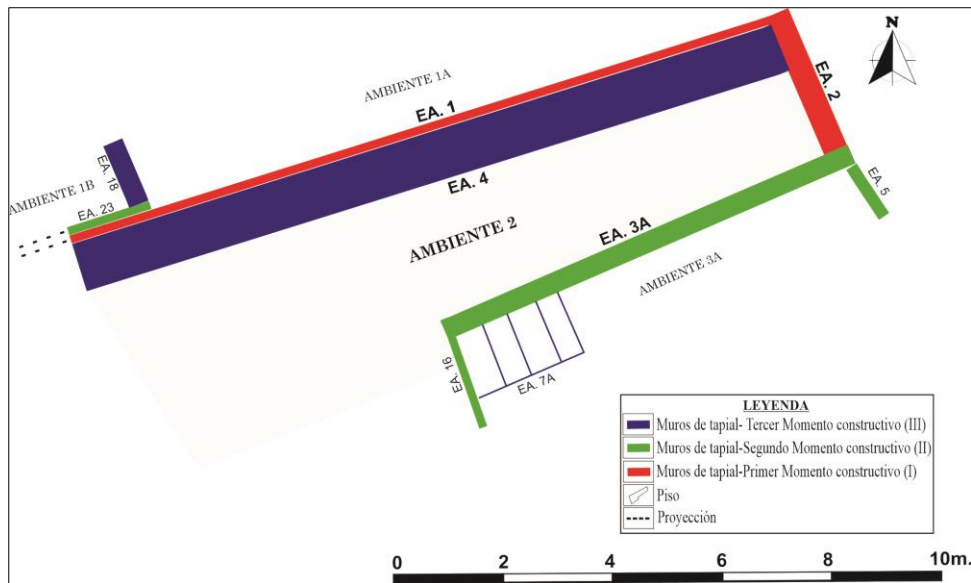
Planta arquitectónica del Ambiente 2 (A-2). Tercer Momento Constructivo (III).
